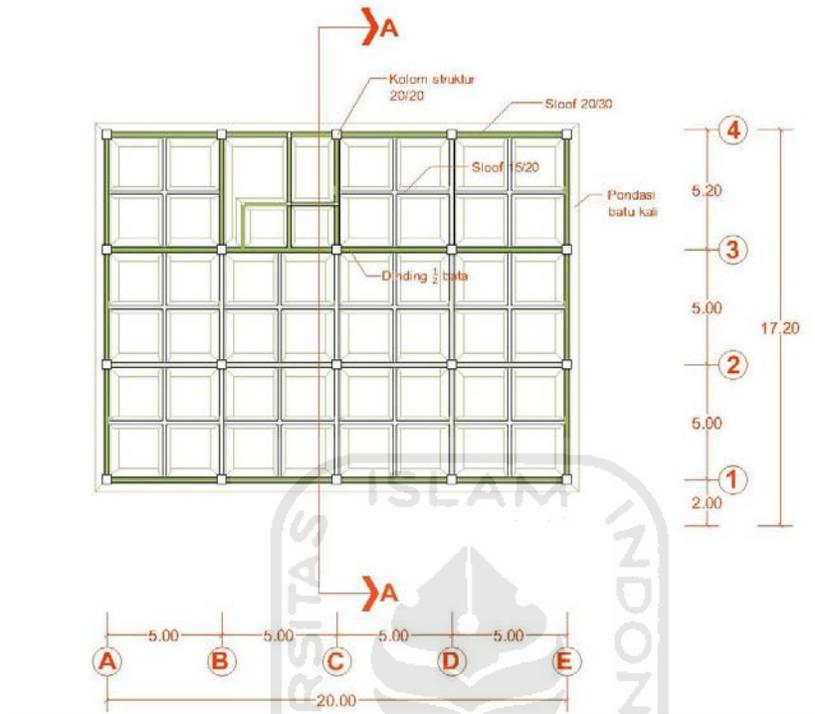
Rencana Pondasi Ruang Terapi
